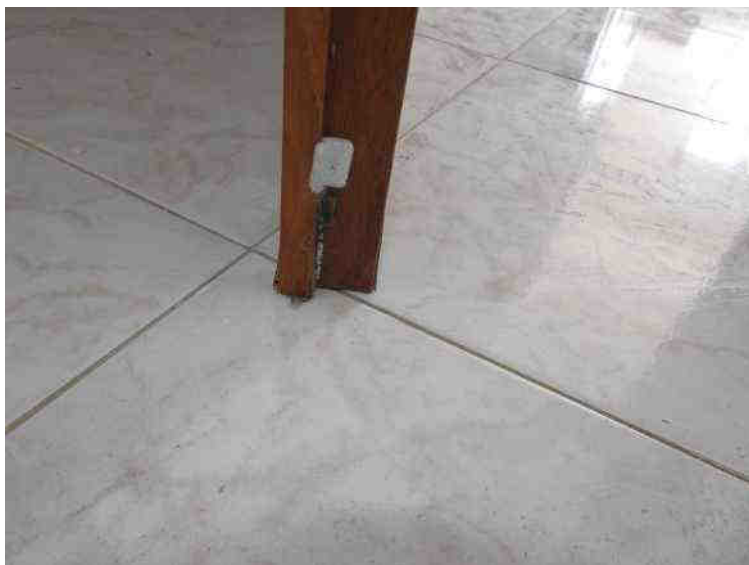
Rigonfiamento spigolo inferiore (stanza 6)
